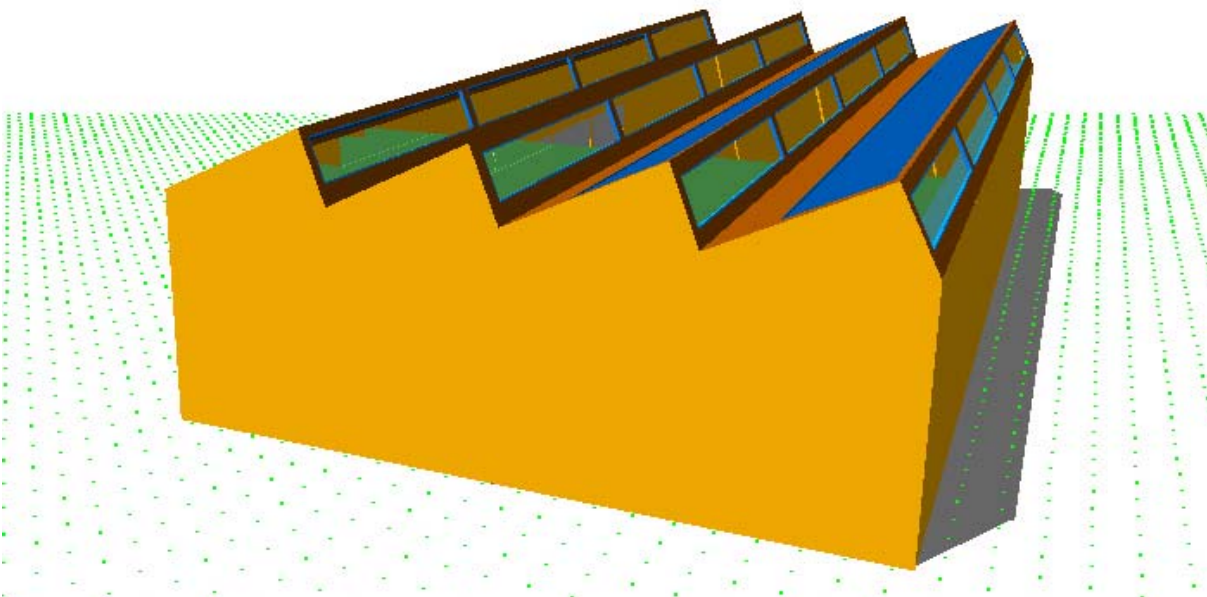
Cubierta en “dientes de sierra”- fachada norte. Se aprecian los lucernarios.
